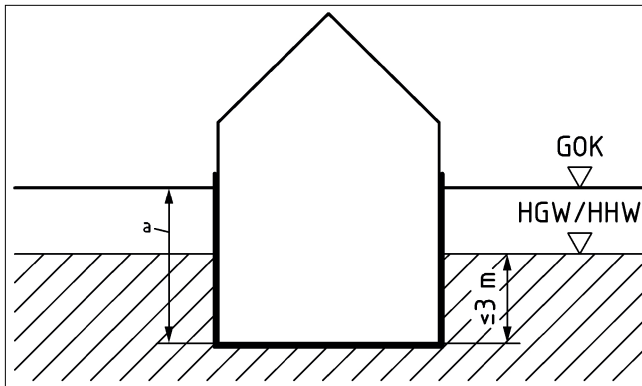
W 2.1-E mäßige Einwirkung von drückendem Wasser - Grundwasser [1]
